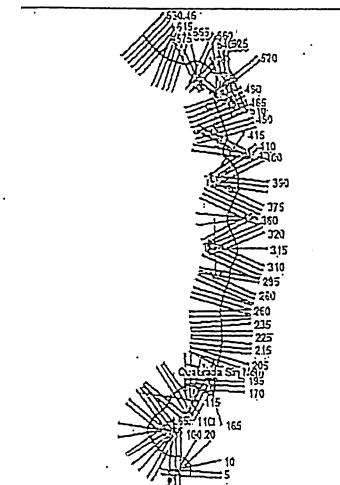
Geometría del Río Previo a la Colocación de la Alcantarilla
